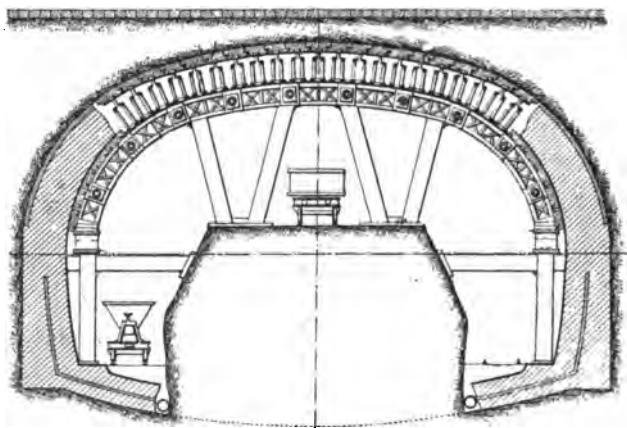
Coupe transversale sous les poutres longitudinales.
